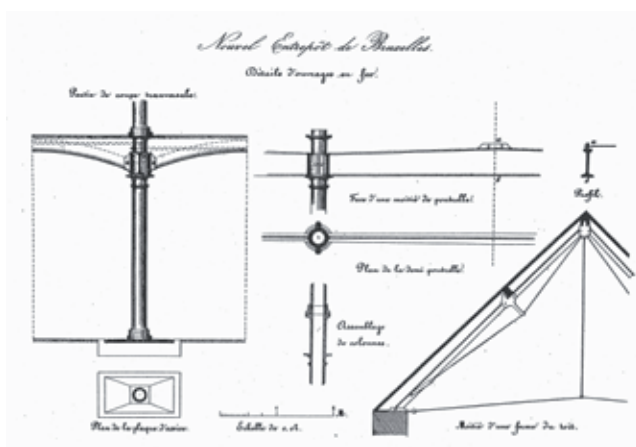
Plan uit 1843 met constructiedetails van het ijzerwerk voor het Koninklijk Pakhuis die verwijzen naar de typische Engelse *fireproof mill* constructie [2].
